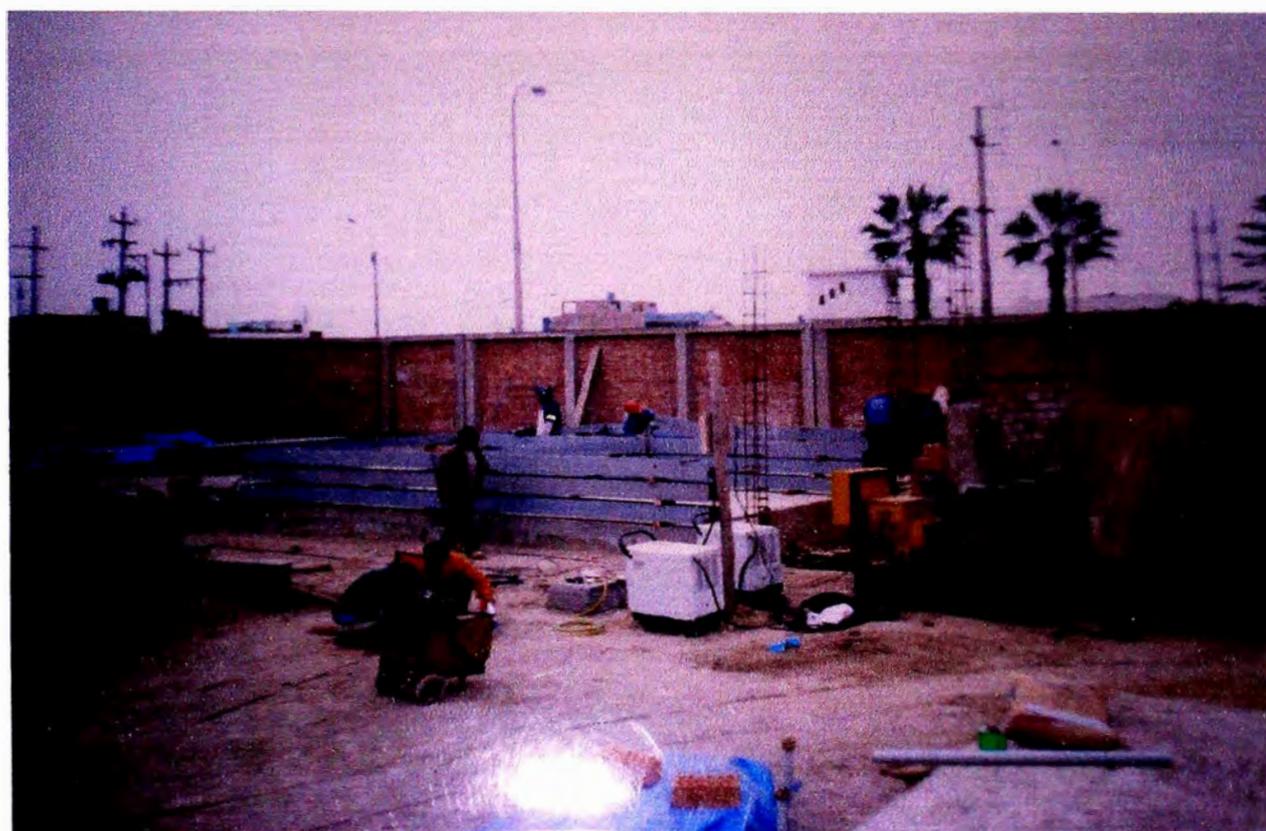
CONSTRUCCION DE CERCO PERIMETRICO Y
